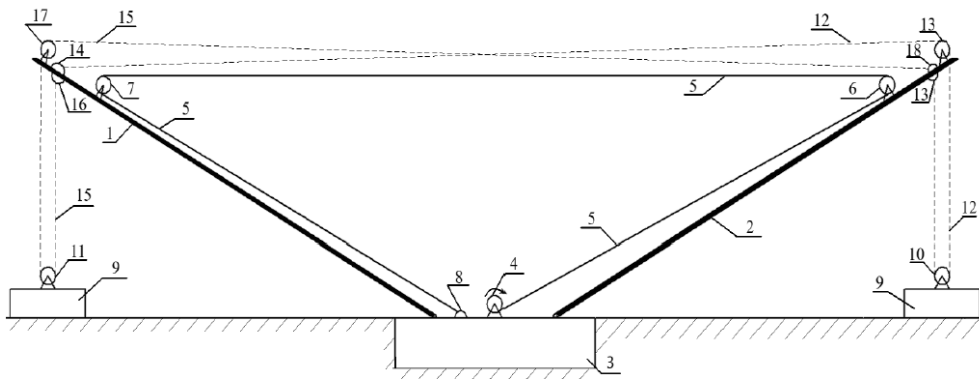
Схема монтажа конструкций несущей рамы здания подвесного типа: 1, 2 – спаренные колонны; 3 – фундамент; 4 – лебёдка; 5, 12, 15 – тросы; 6, 7, 10, 11, 13, 17 – блоки; 8 – крепления троса к фундаменту; 9 – временные противовесы; 13, 14, 16, 18 – крепления тросов к колоннам
